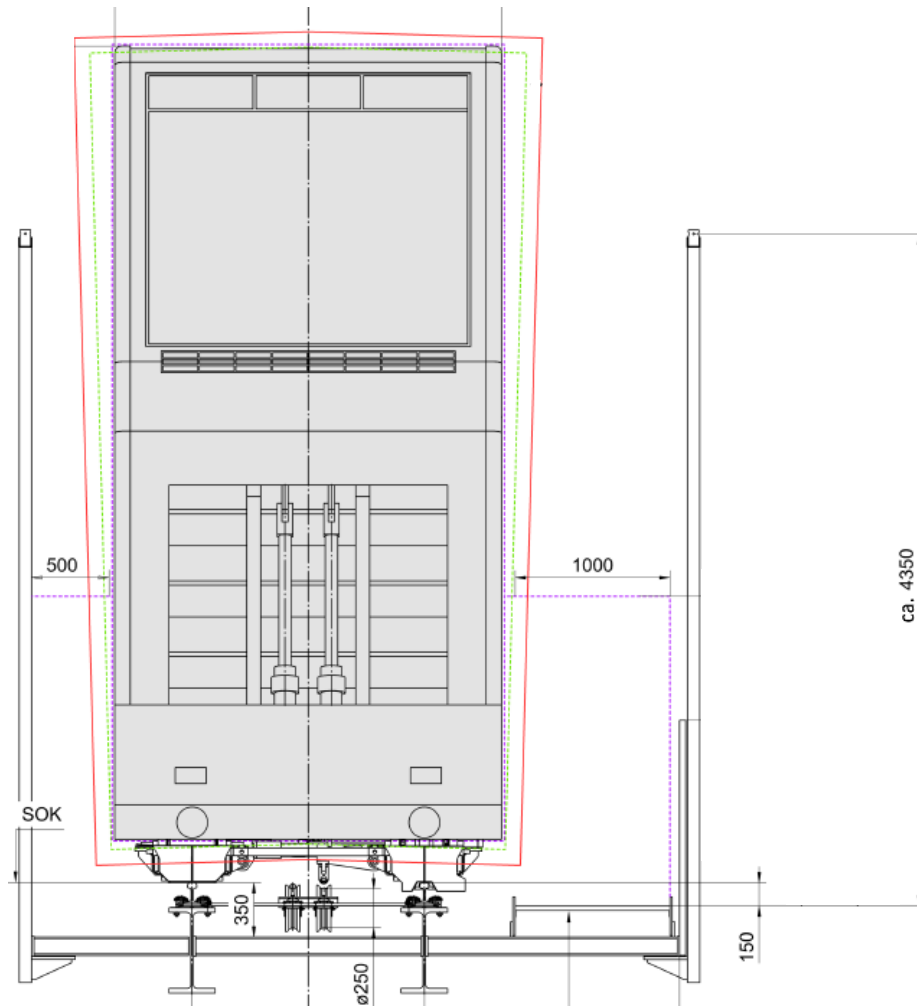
Baumfalleitung im Bereich Stahlfahrbahn
